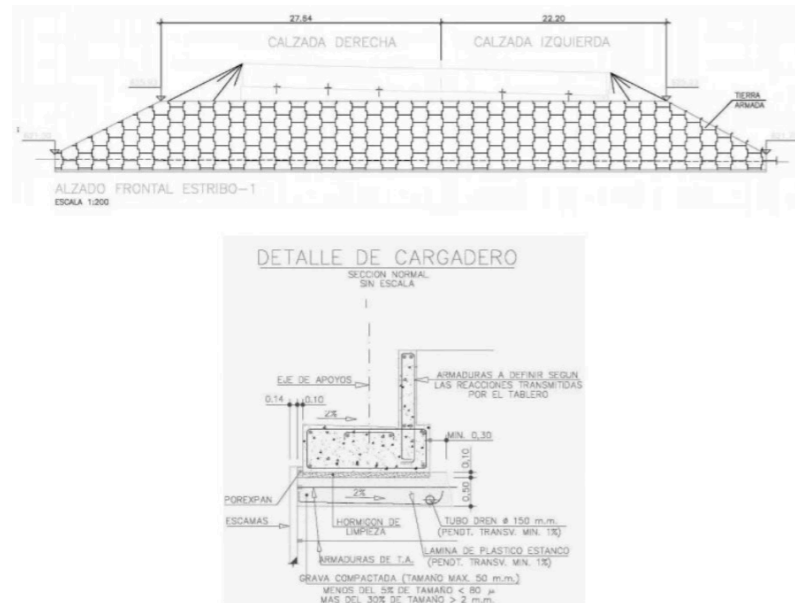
Alzado frontal y detalle del muro cargadero del estribo de tierra armada. Fuente: Blog structuralia.
